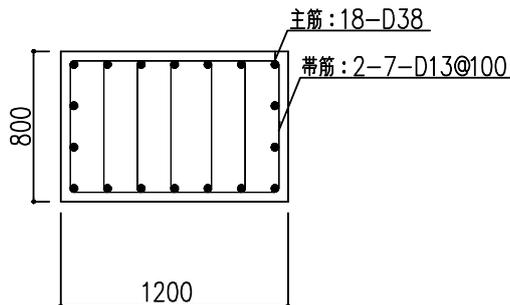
柱の配筋図 (地下2階, X3/YF 通り, 柱脚部) (単位: mm)
